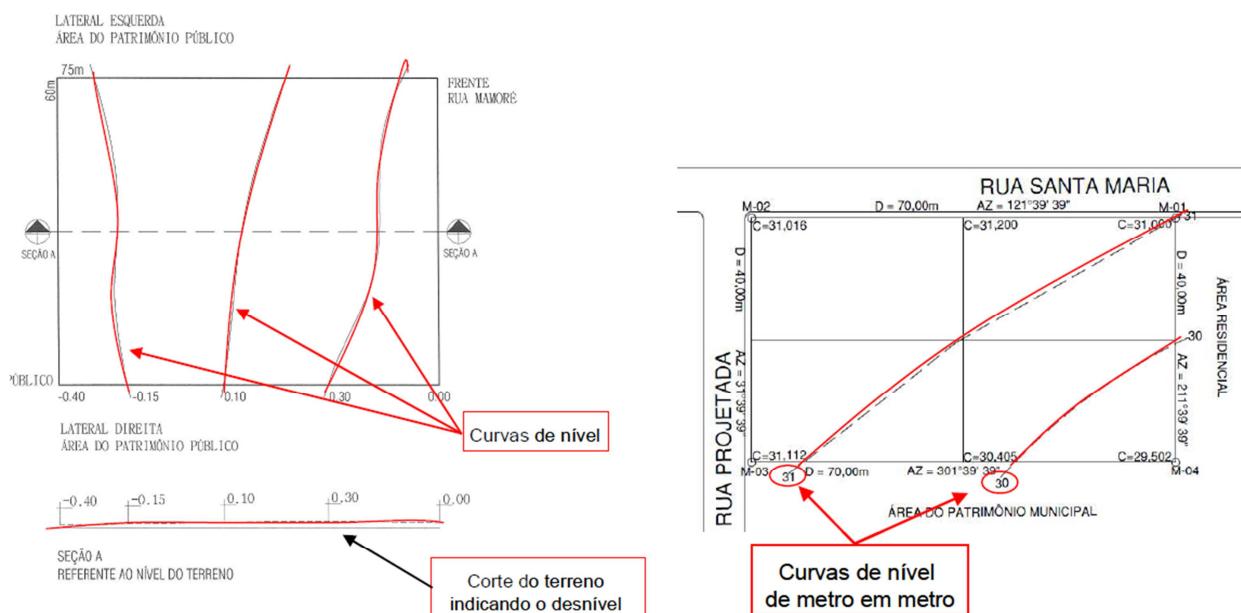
Exemplo de “Planta de Levantamento Planialtimétrico” satisfatória.
